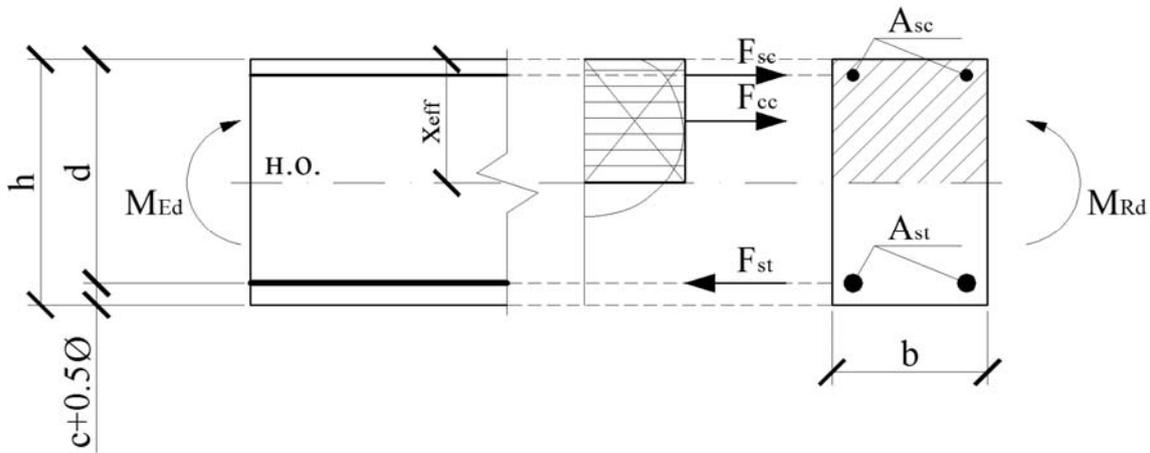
Расчетная схема элемента с двойным армированием
